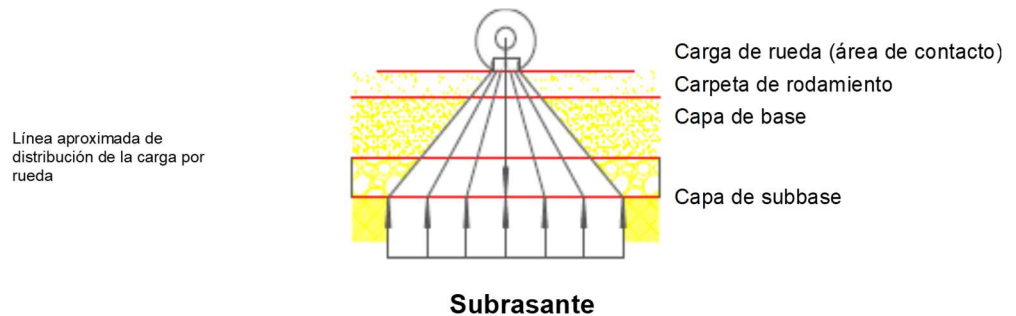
Distribución de carga de una rueda en el pavimento flexible
